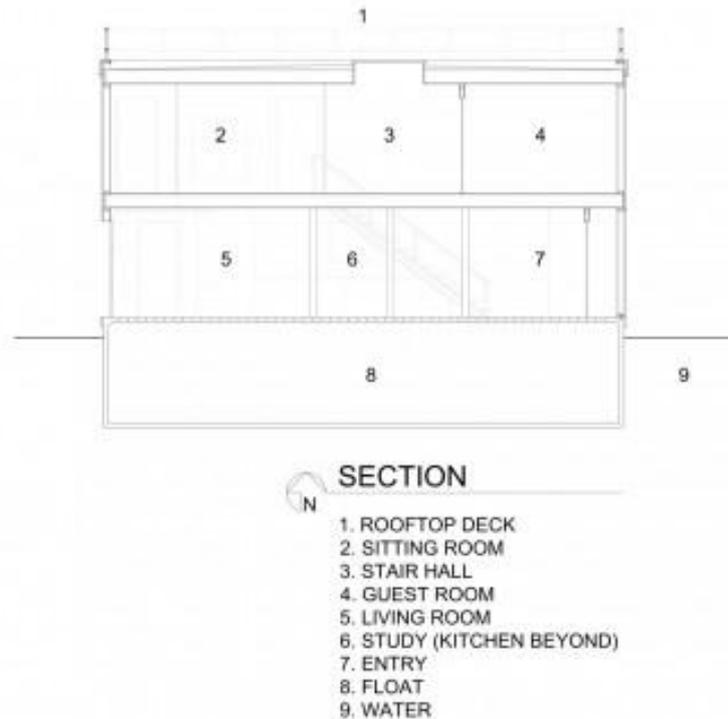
Sección arquitectónica de una vivienda flotante en Seattle, Washigton.
